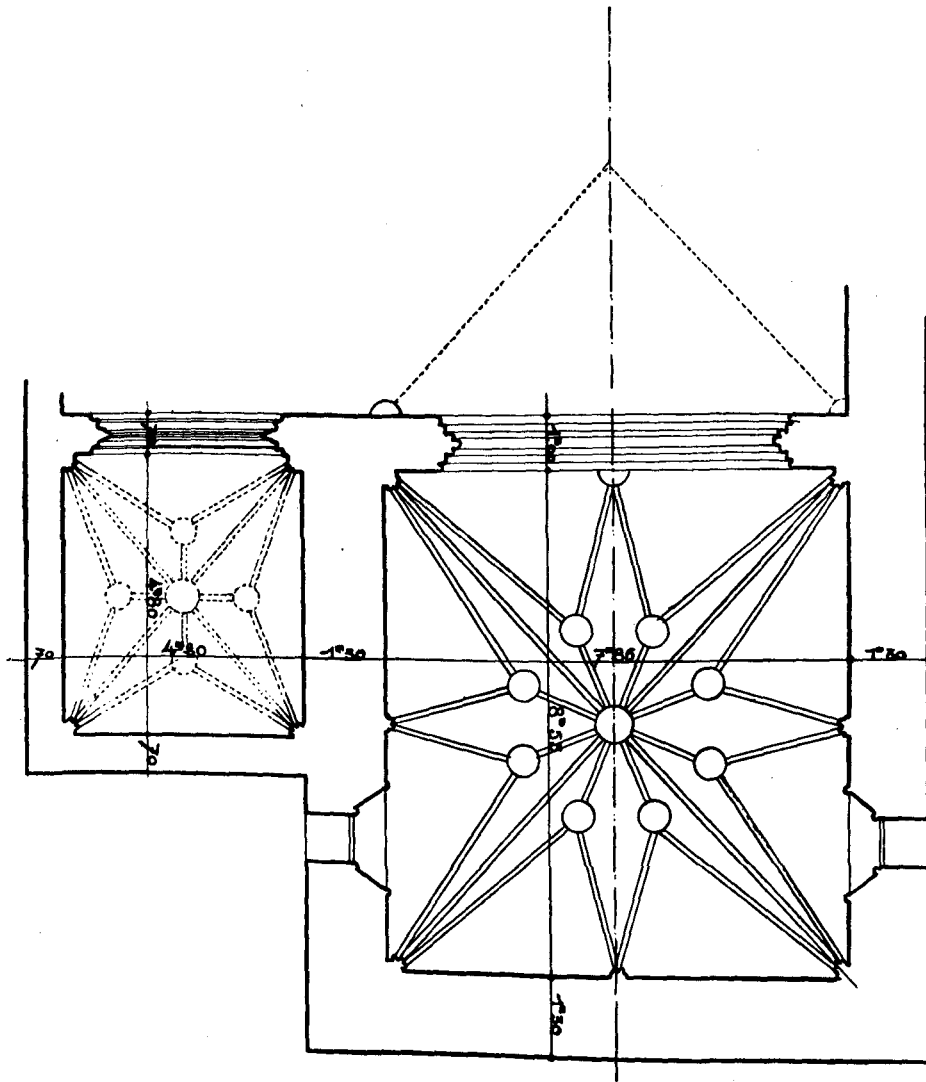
Chœur de la cathédrale de Safi : plan.
